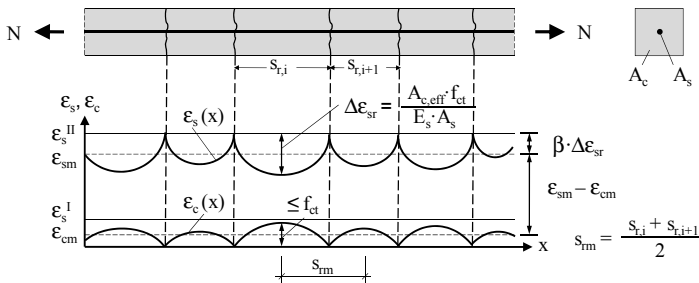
Dehnungen im Stahlbetonzugstab bei abgeschlossenem Rissbild
